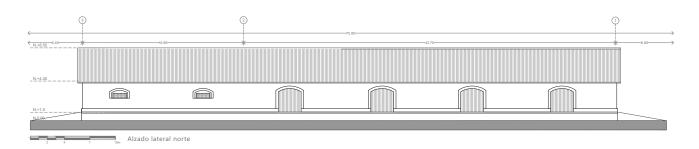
Fachada lateral norte de Bodegas . Fuente: Elaboración de la autora.
